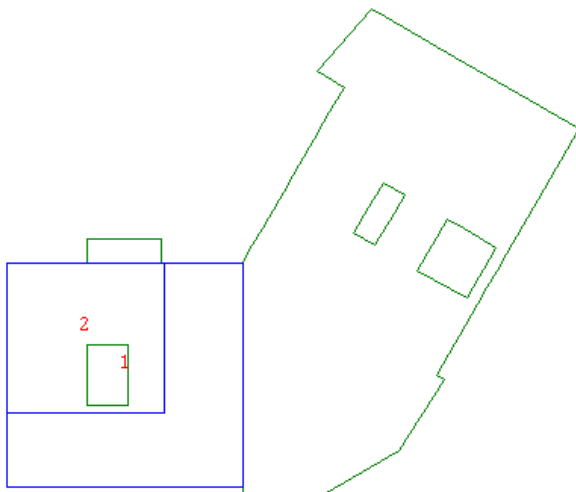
Схема участков раскладки сеток с номерами зон (фрагмент)
